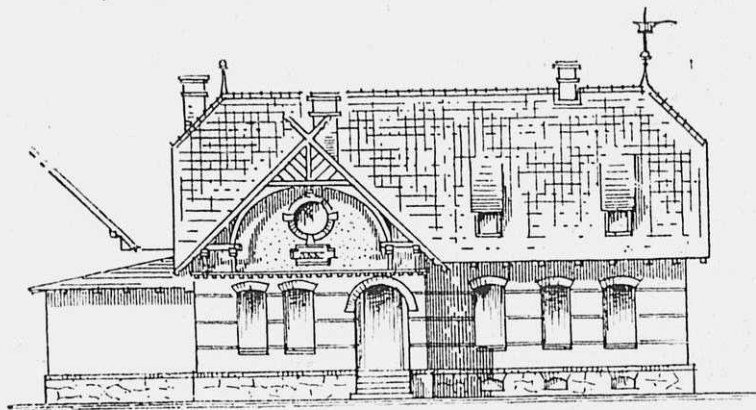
Хозяйскій домъ на крупномъ хуторѣ (изъ камня, бетона и самана). Фасадъ.
